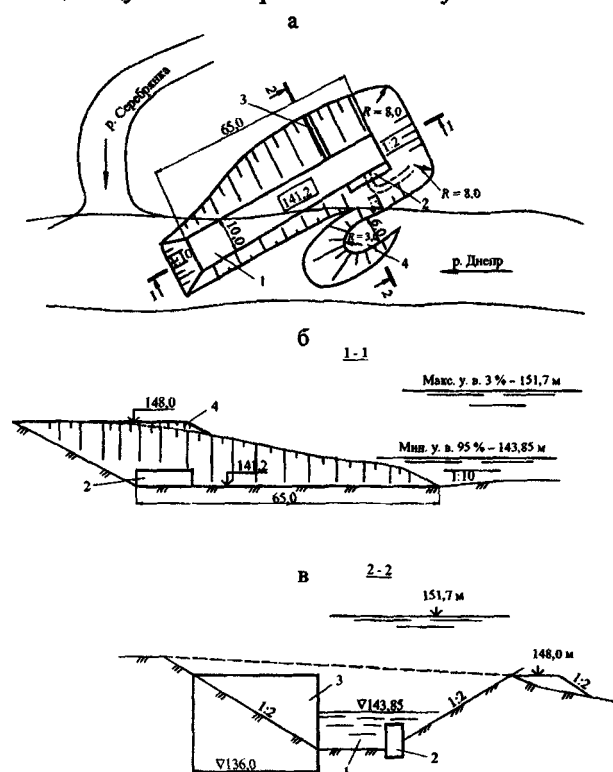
Схема водозаборного ковша: а — план; б — продольный разрез 1-1; в — поперечный разрез 2-2; 1 — канал-ковш; 2 — водоприемник; 3 — шпунтовая стена; 4 — струенаправляющая дамба
